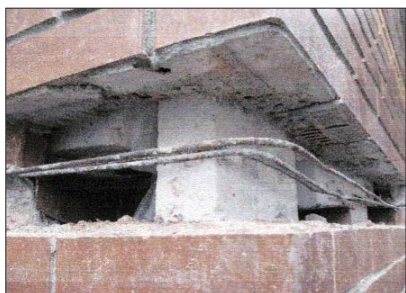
г Армирование наружного слоя стены отдельными стержнями
